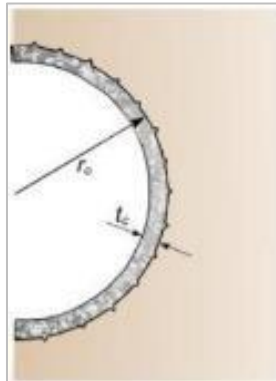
Hormigón lanzado en una excavación de sección circular. Fuente: (González, 2015)
